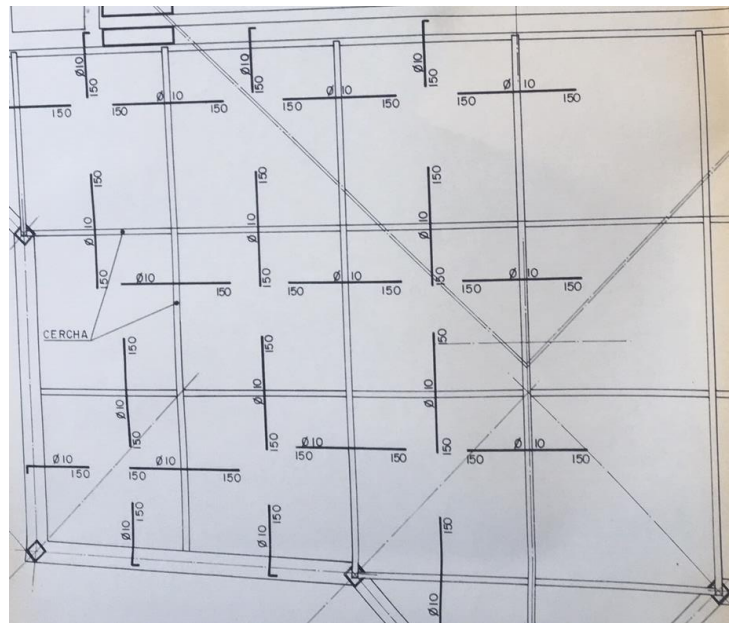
Planos de proyecto. Armadura de negativos en cubierta de sala (EL+23.30) y en la caja escénica (EL+27.20)
